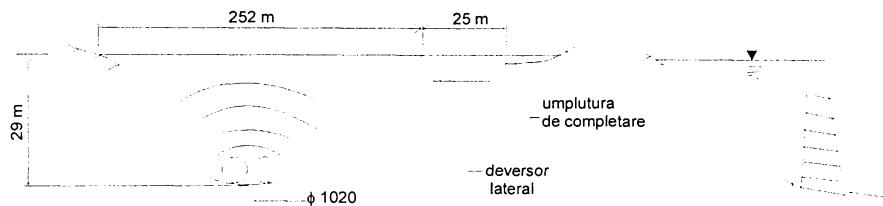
Ipoteza de rupere a barajului Trei Ape
